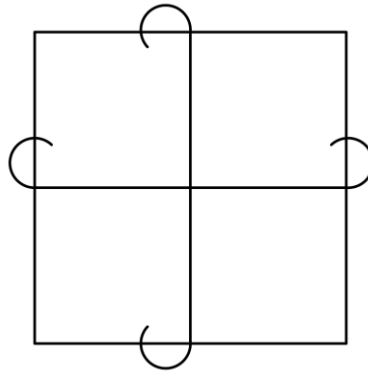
Ganchos en Columnas para Confinar el Hormigón. Fuente: Nicolás Pozo
